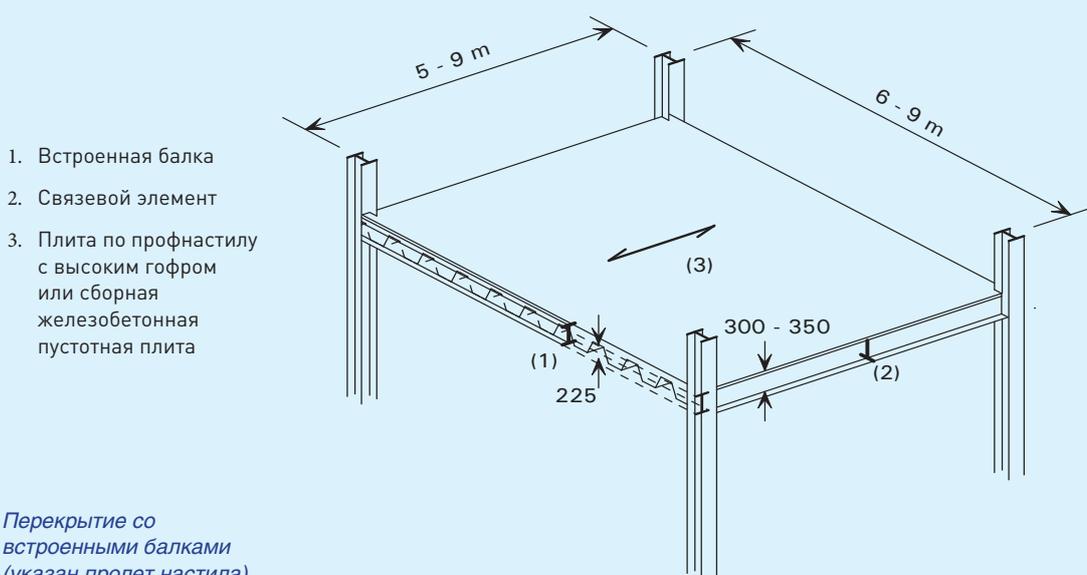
Перекрытие со встроенными балками (указан пролет настила)
